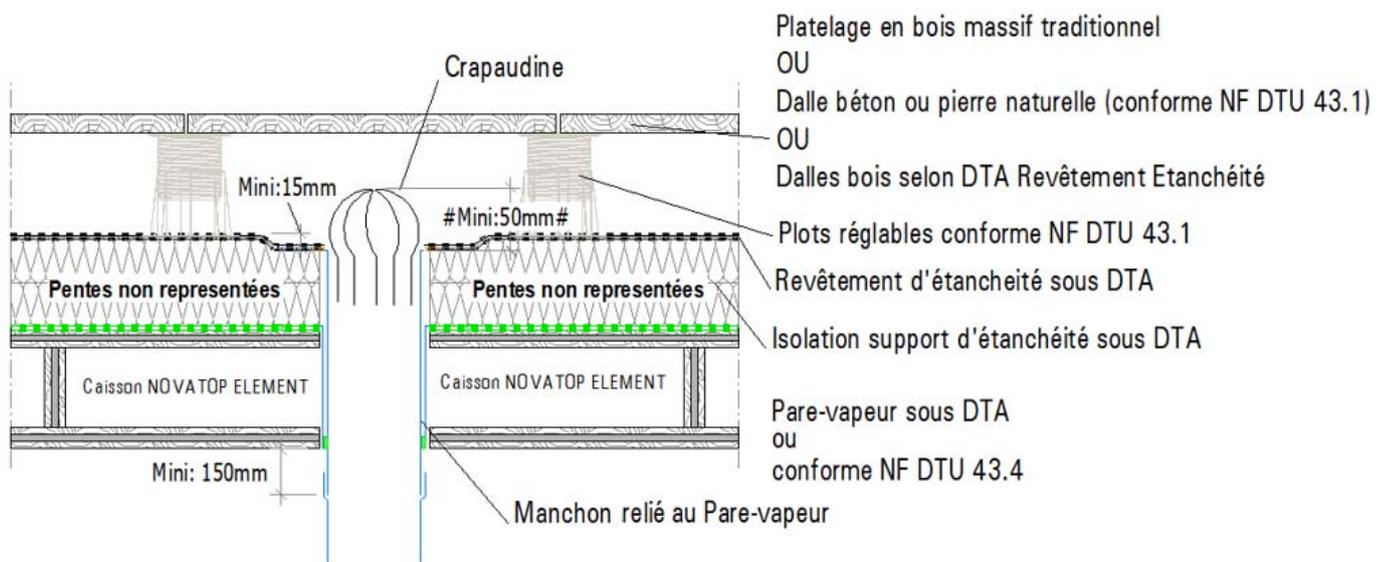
A – Naissance descente EP (terrasse accessible aux piétons et séjours)
